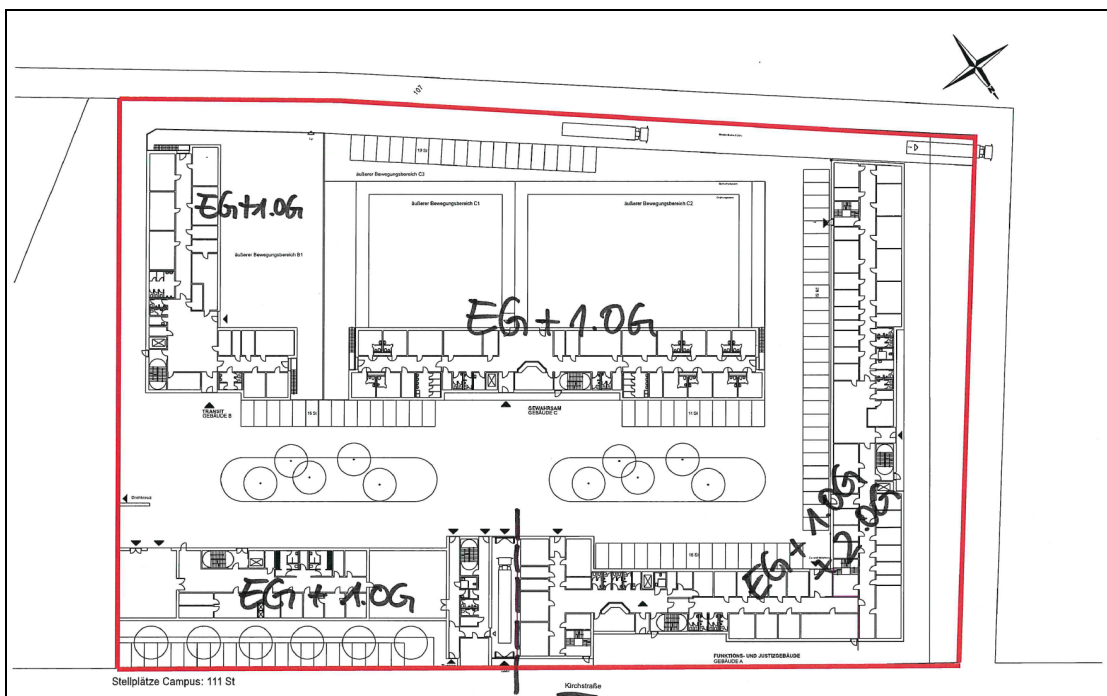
Grundriss mit Geschossangaben; Planstand: 07.06.2023 [U 2]
